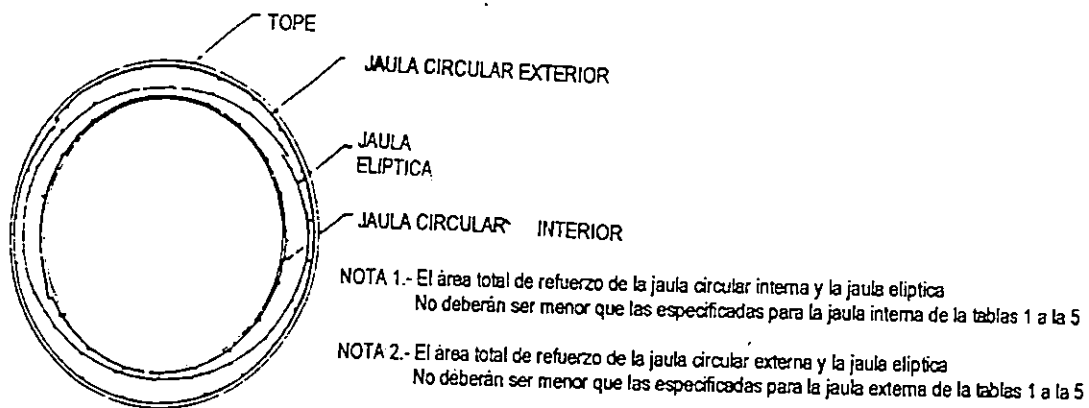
Sección transversal de los tubos de concreto armado para alcantarillas.
